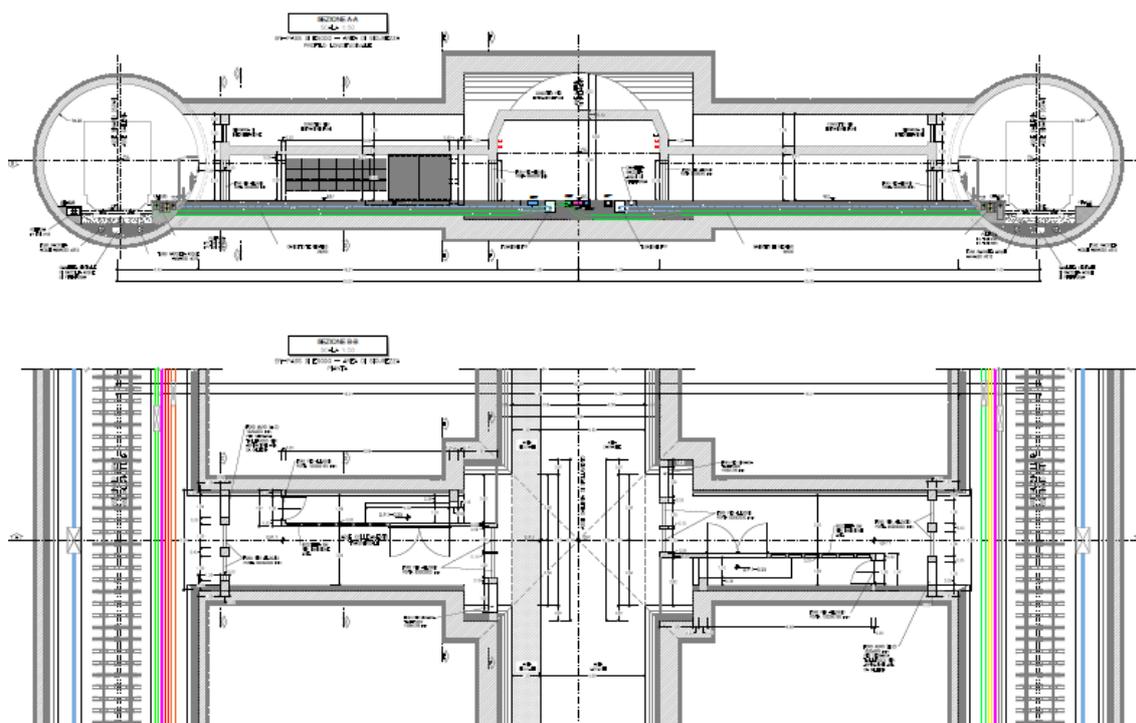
sezione e pianta by-pass emergenza area di sicurezza tipico
